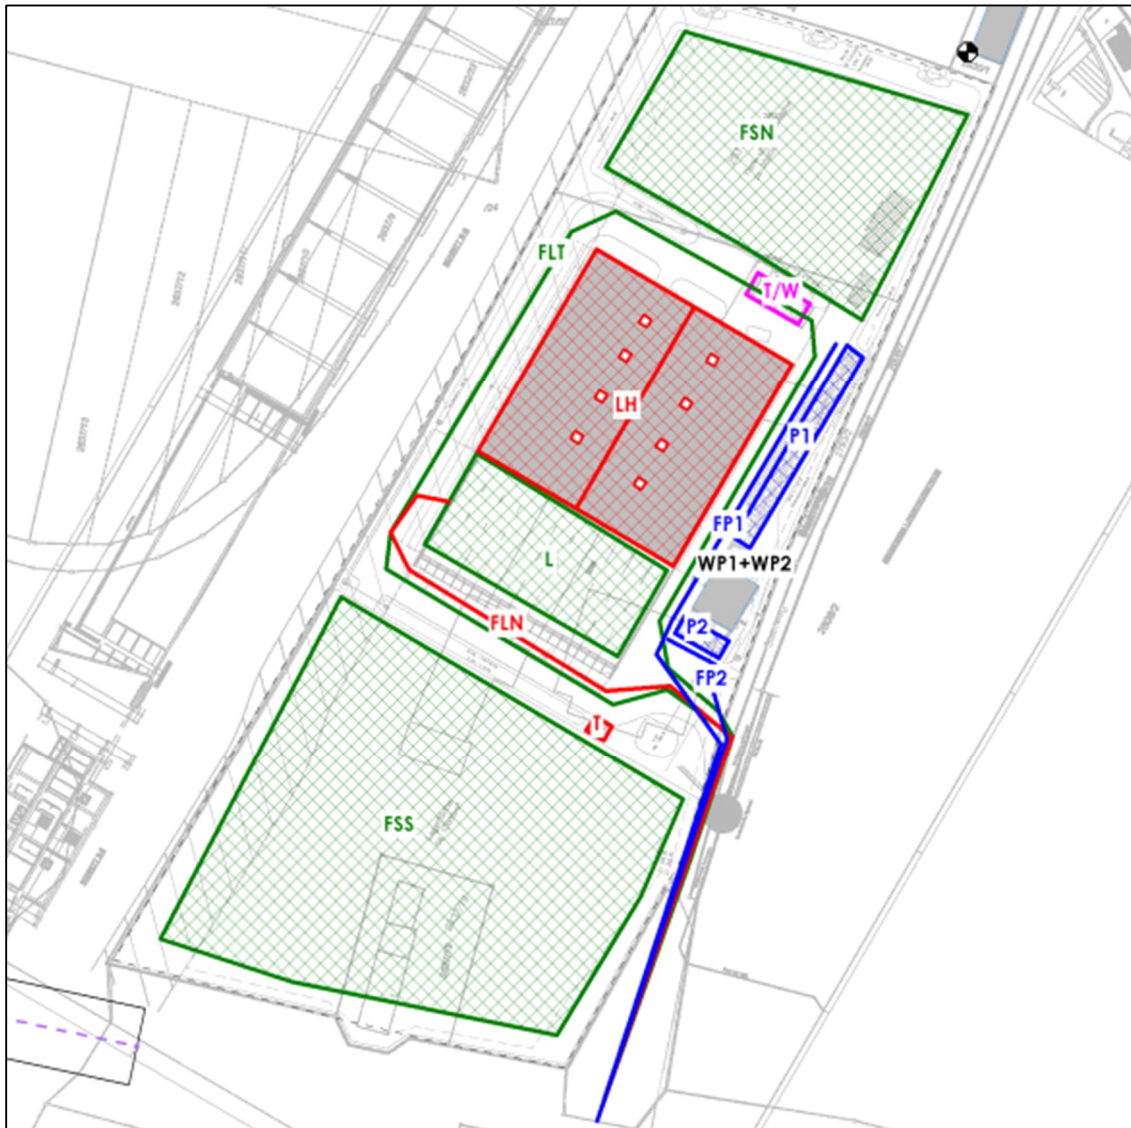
Lageplan mit Darstellung der relevanten Schallquellen
